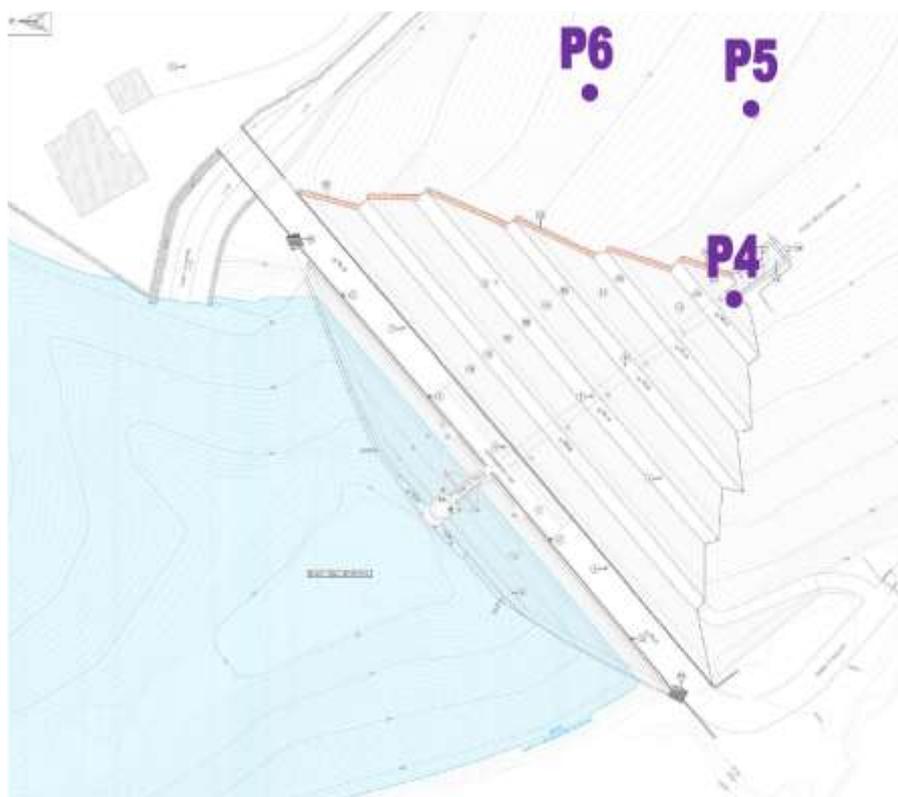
estratto planimetria ubicazione dei punti di campionamento
